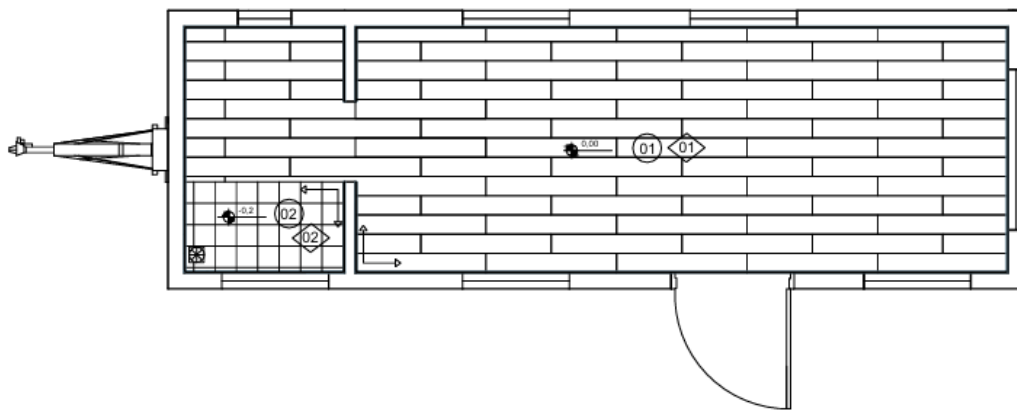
Planta baixa cotada da Tiny House. - Fonte: Elaboração própria.
